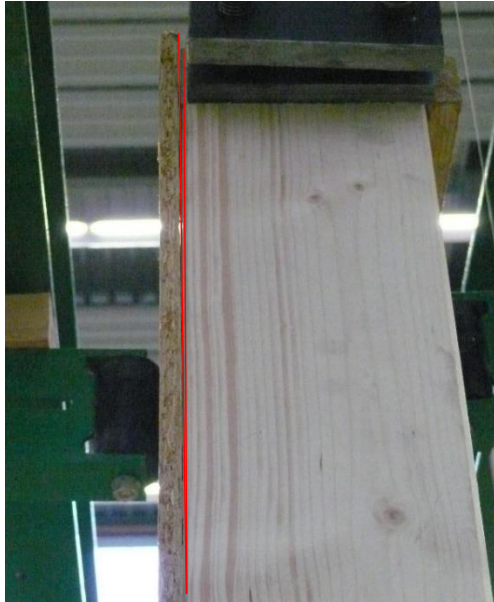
Reißverschlussartiges Öffnen der Verbindungen zwischen Beplankung und Unterkonstruktion. Quelle: VHT
